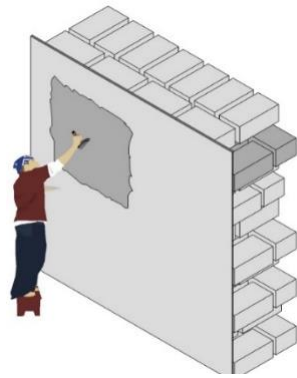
Aplicado de afinado. Fuente: Elaboración propia.
